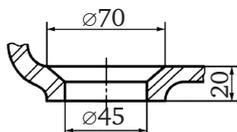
Размеры отверстия в чаше умывальника для установки выпуска воды
